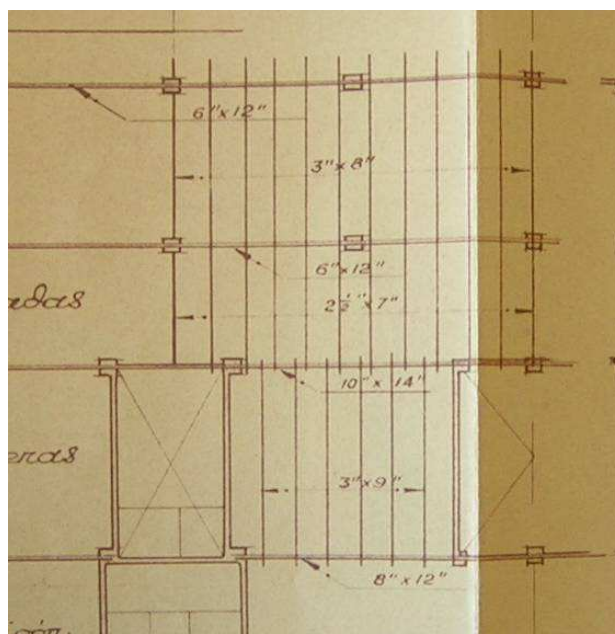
Planta estructura. Edificio ficha 79C.005, 1950.
